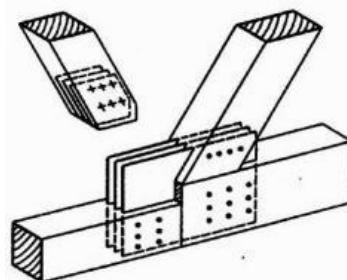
Узел фермы с гвоздевым соединением элементов при помощи накладок
